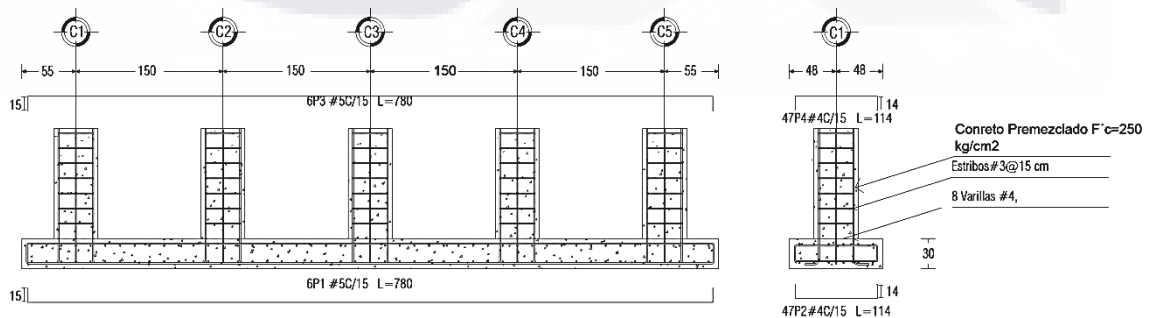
Detalles del armado de la cimentación a base de zapatas y dados de concreto reforzado.
